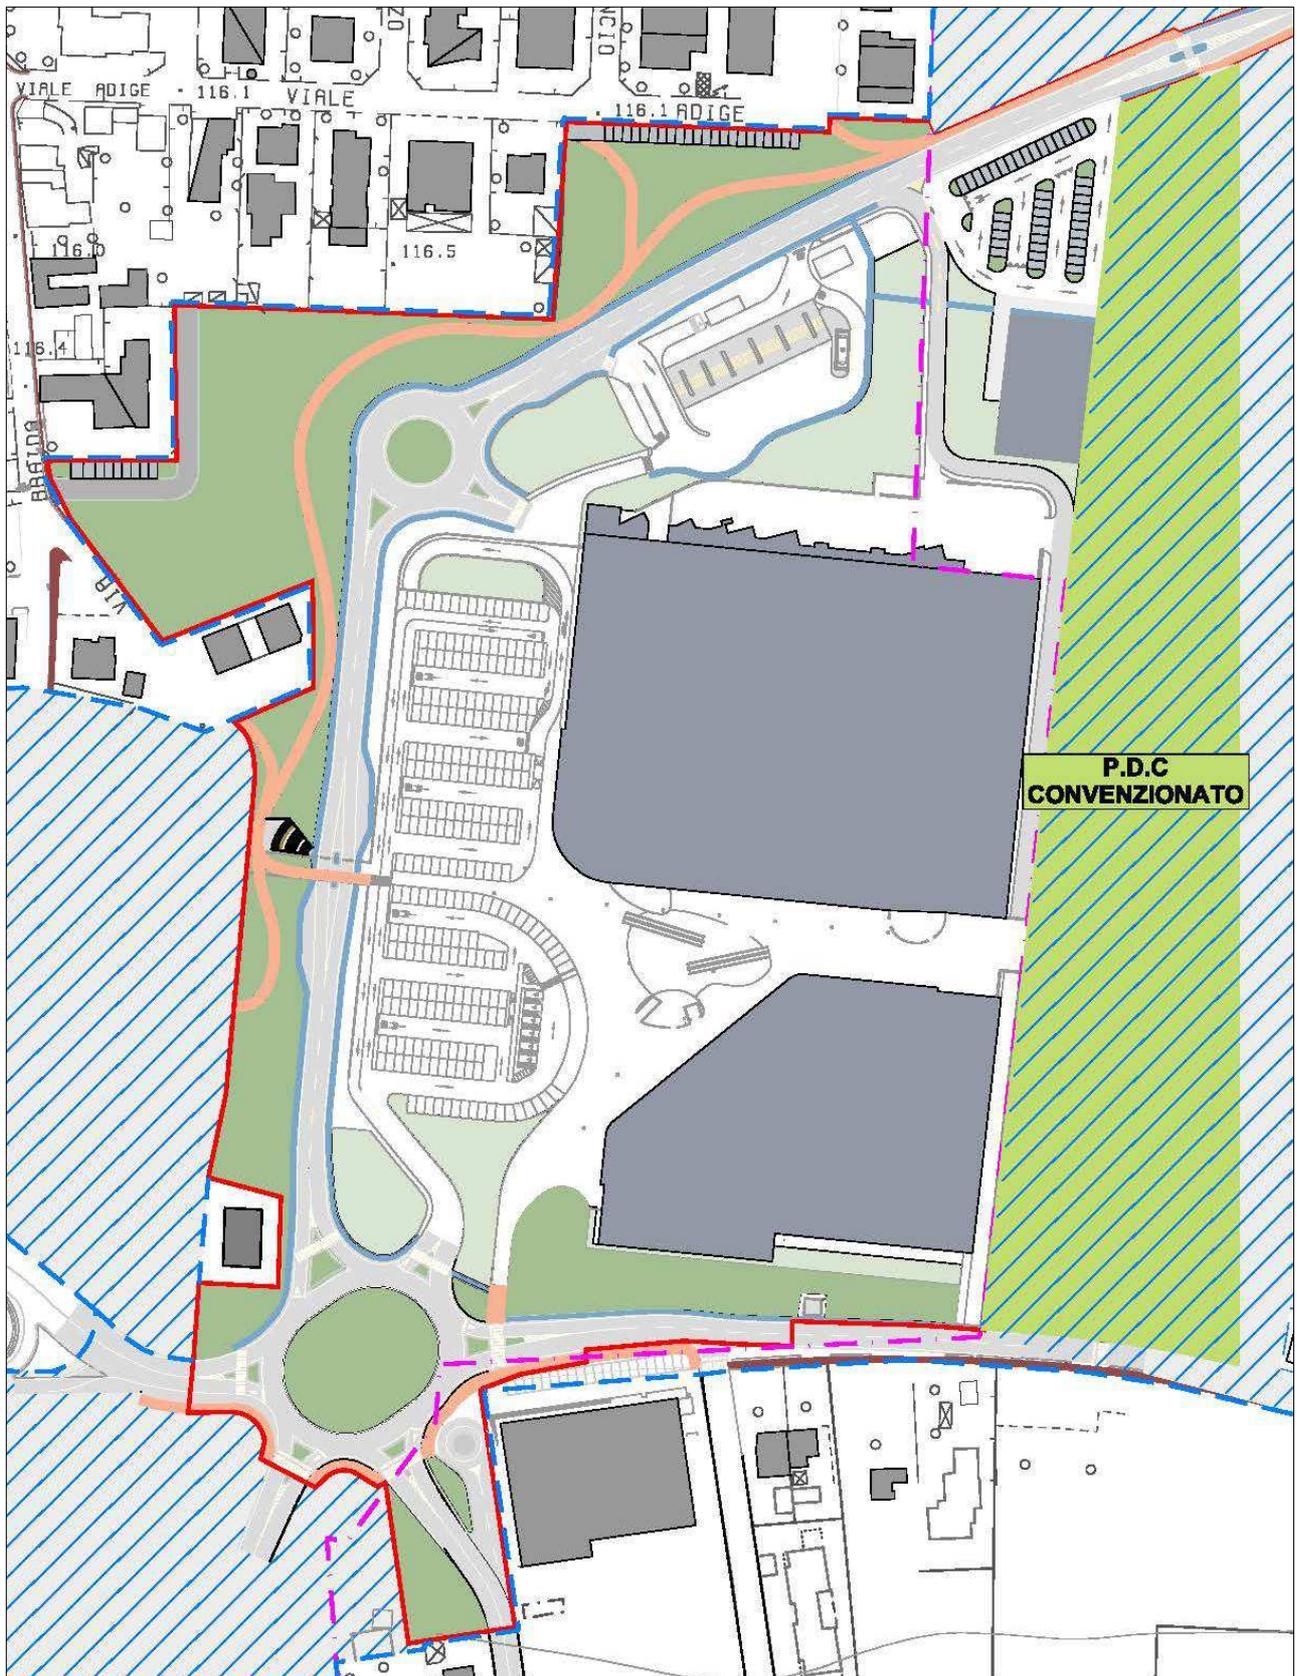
Planimetria generale degli interventi assoggettati a P.U.A
